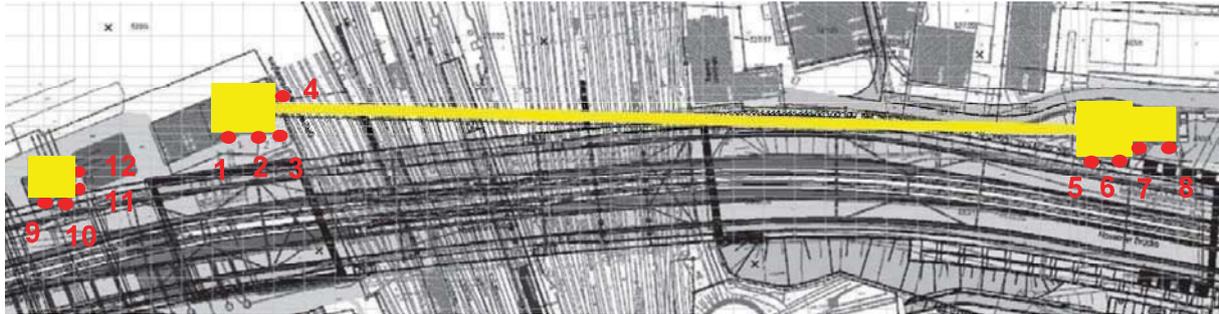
Ausschnitt aus Bild 2 mit den gelb markierten Bauwerken und mit rot markierten Standorten der Beobachtungsbrunnen.
